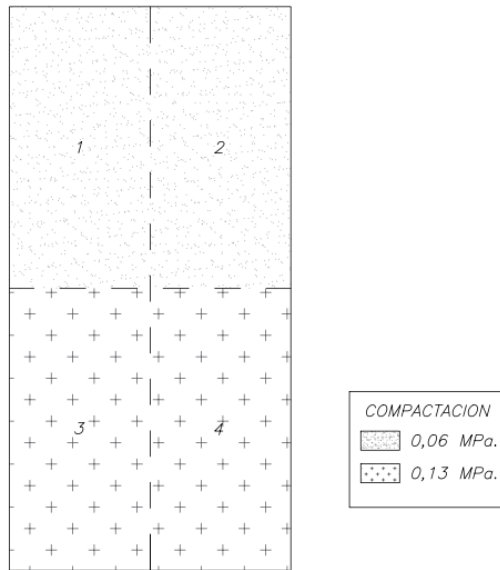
Infiltración en sección de pavimento con método ASTM C1701
